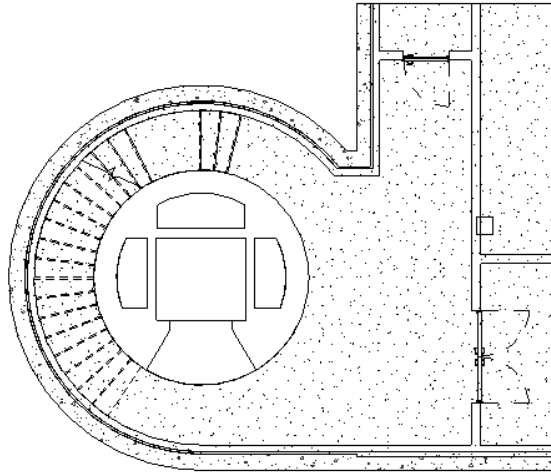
Colocación de muros en nivel subsuelo (Vista de planta del nivel subsuelo)
